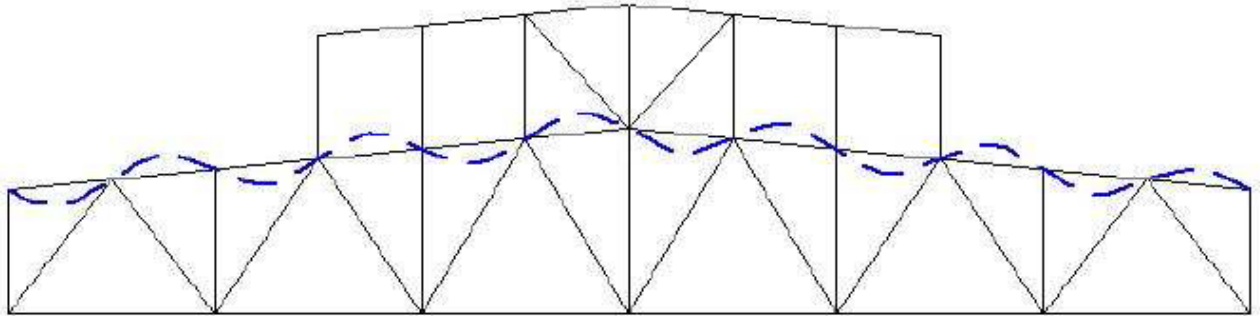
Форма потери устойчивости верхнего пояса фермы (пунктир).
